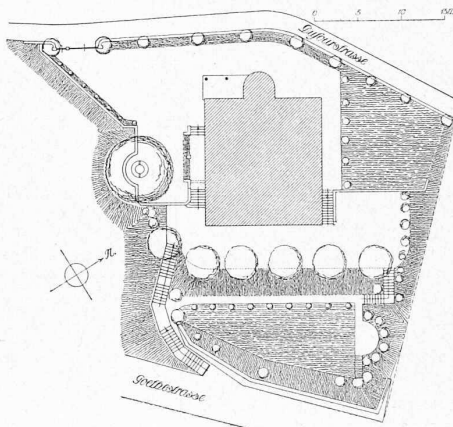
Lageplan der „Laimsburg“. — 1 : 800.
